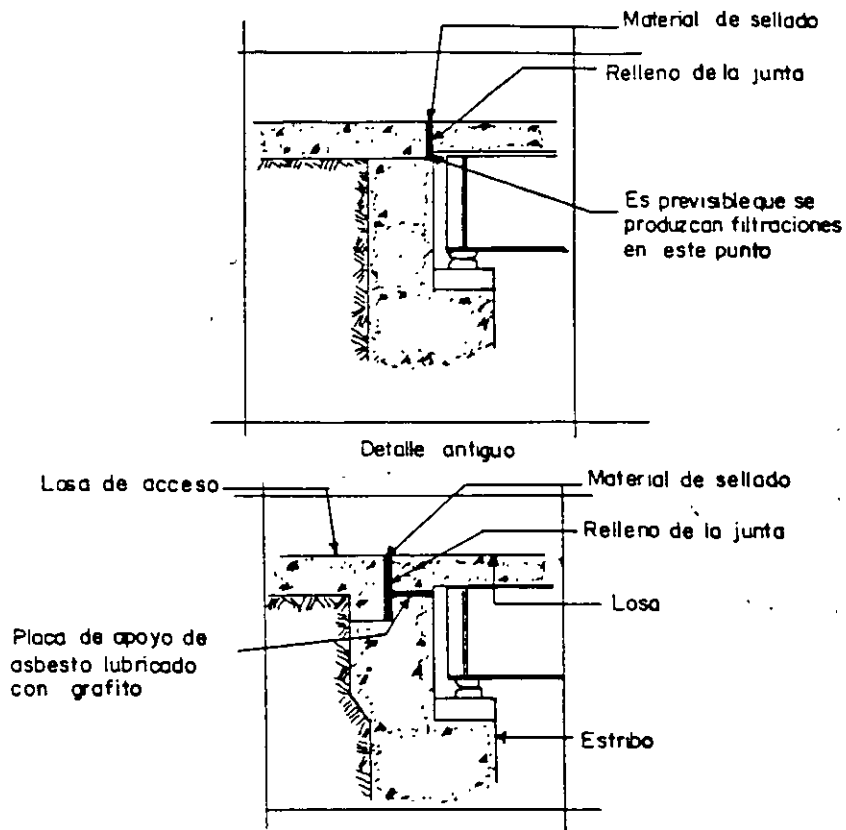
Modificación de un detalle de un apoyo en un estribo para detener la penetración del agua en la junta de dilatación
